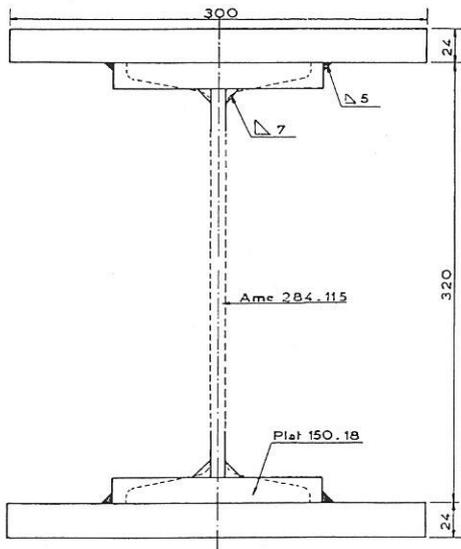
Profil composé par soudure employée pour colonnes.
